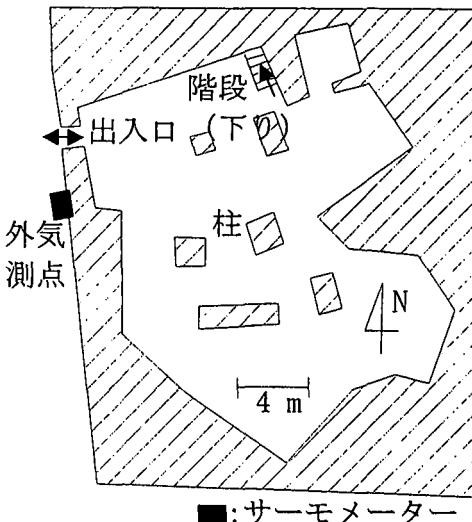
地下商店（Store 4）の平面図. 外壁で外気の温・湿度を測定. 天井高さ 2.25 m, 土被り厚約 10 m.
